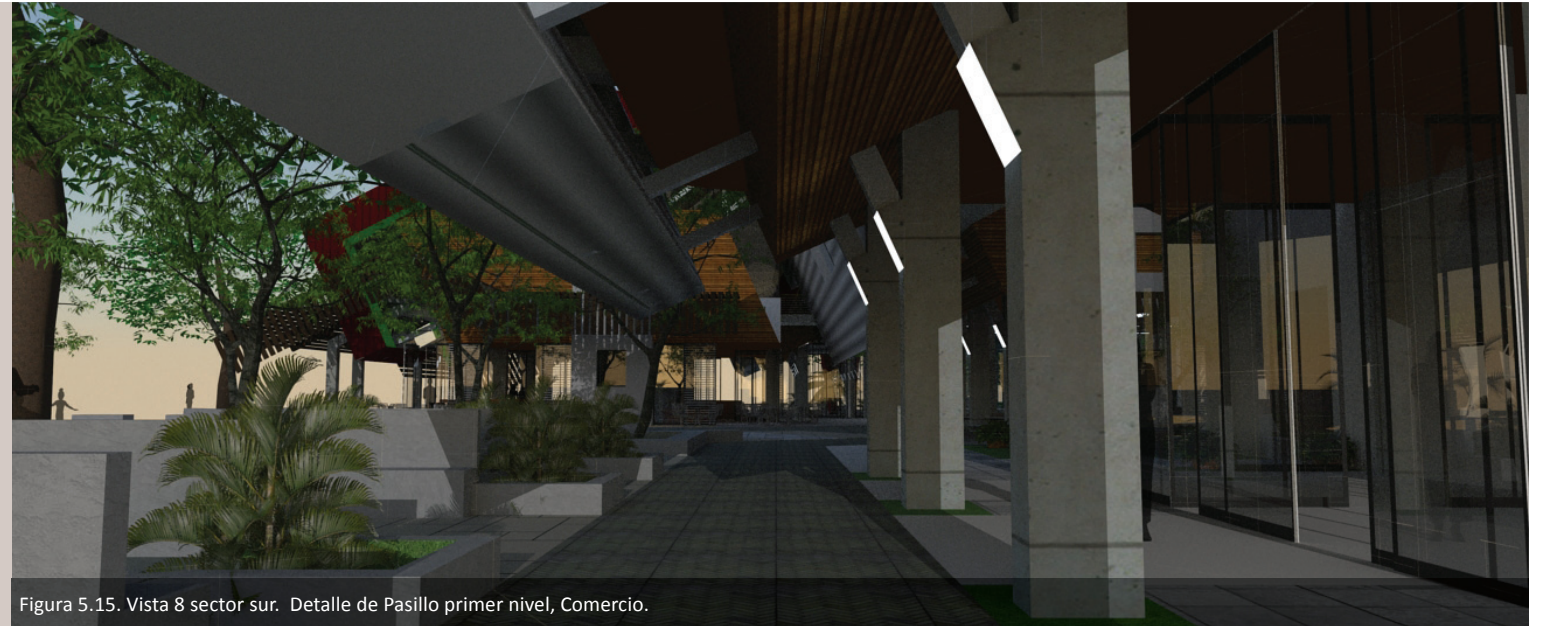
Vista 8 sector sur. Detalle de Pasillo primer nivel, Comercio.
